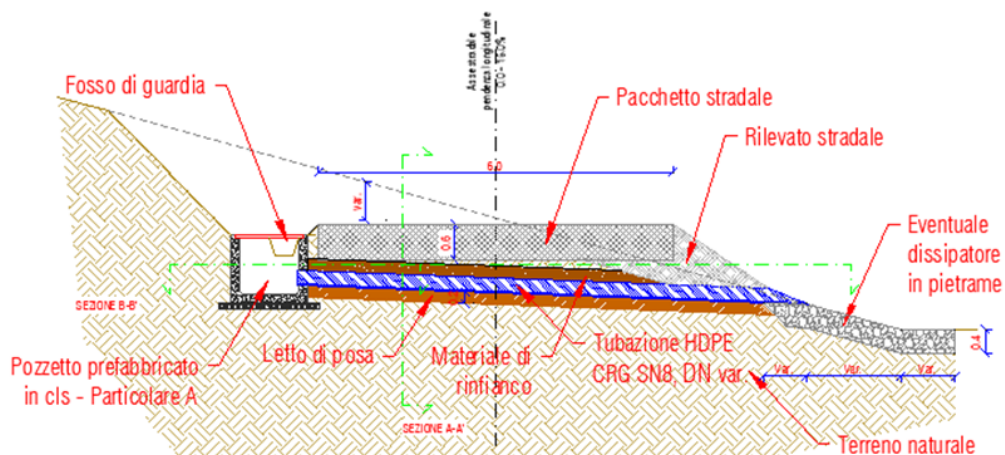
Estratto da tavola di progetto - Attraversamento stradale di scarico.
